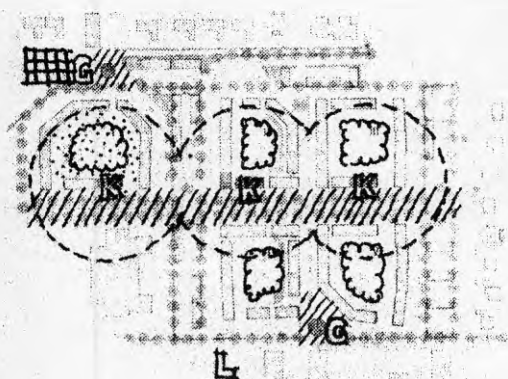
Jerk Altons förslag, situationsplan. Detalj från originalet.
